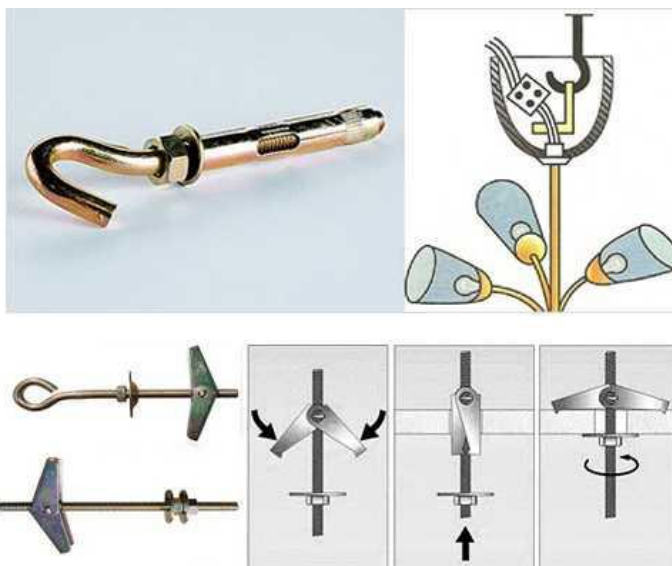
Крепление люстры на крюк с дюбелем
